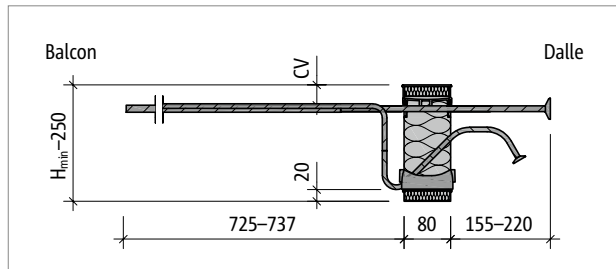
Schöck Isokorb® T type K-U-M2 : coupe du produit
